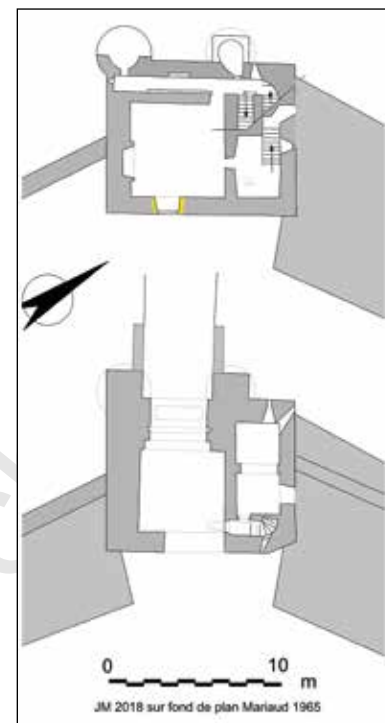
Sagonne, château, plans de la tour-porte au rez-de-chaussée (en bas) et au premier étage (en haut) [Dessin J. Mesqui sur fond de plan Mariaud 1965].
